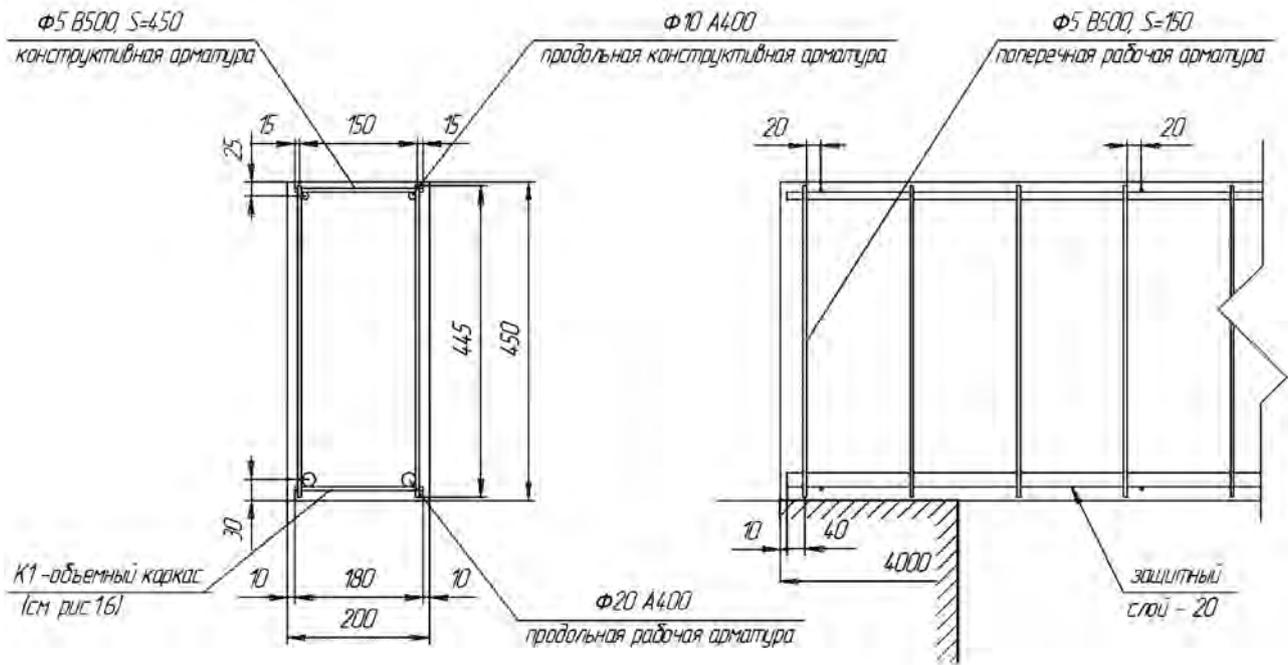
Схема расположения арматуры в опалубке железобетонной балки
